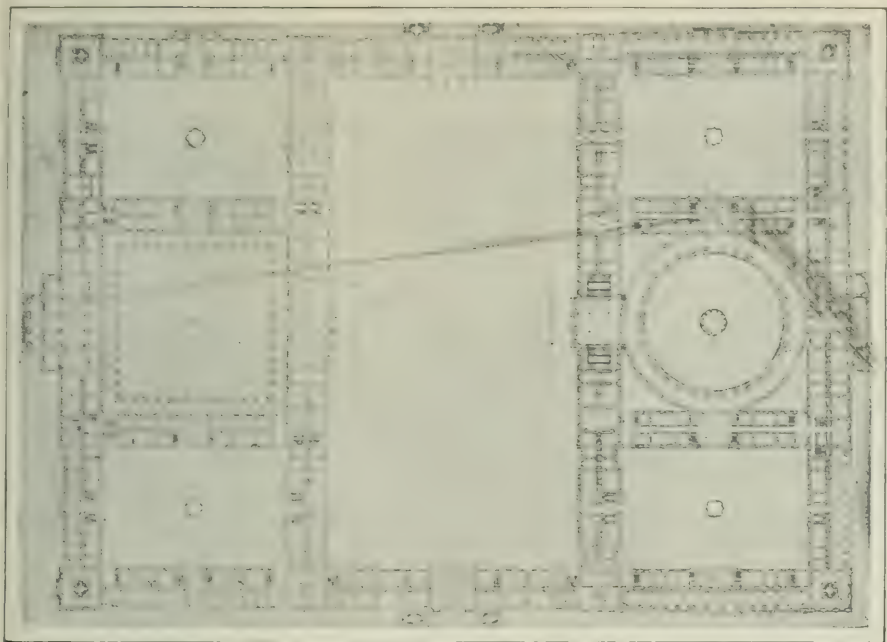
PLAN DU REZ-DE CHAUSSÉE DE WHITEHALL.
